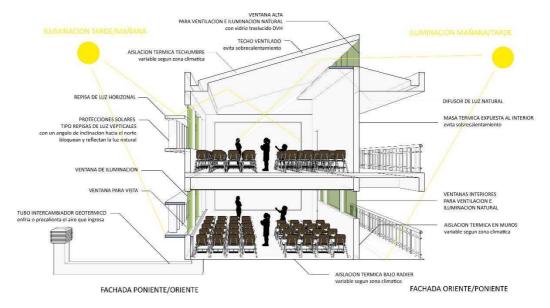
Disposición de bloque de aulas Fuente: arquitectura.ubiobio.cl
